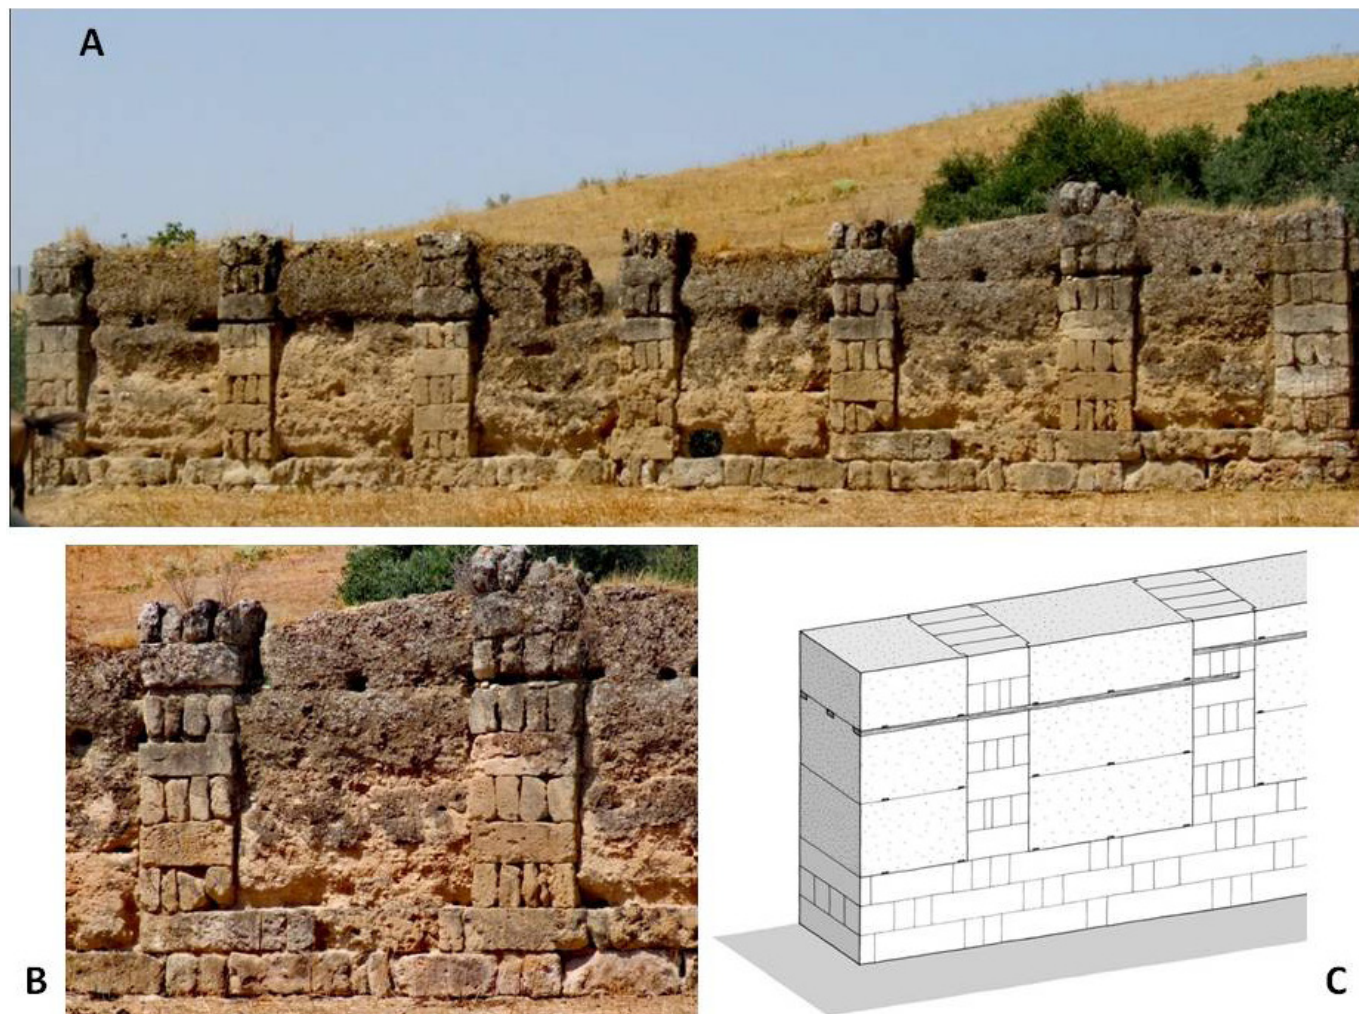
Muro de tapial encadenado documentado en la almunia de al-Rummaniyya. A. Muro completo. B. Detalle de una de las secciones entre machones. C. Detalle del muro (según Arnold *et al.* 2008).
